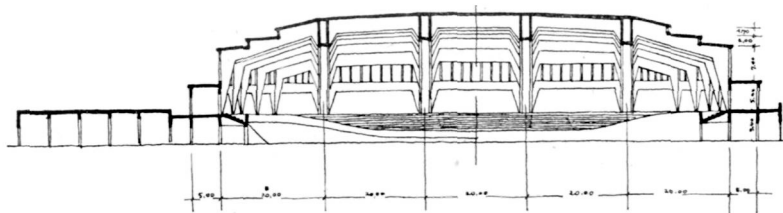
Westfalenhalle Dortmund. Längsschnitt
